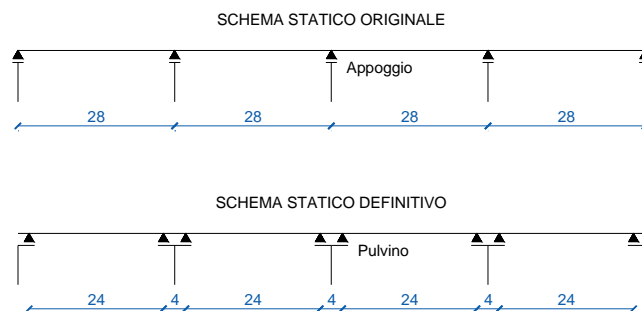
Schema statico originale con appoggi su pile (luci di 28 m) e schema statico definitivo con pulvini (luci di 24-4-24 m)
